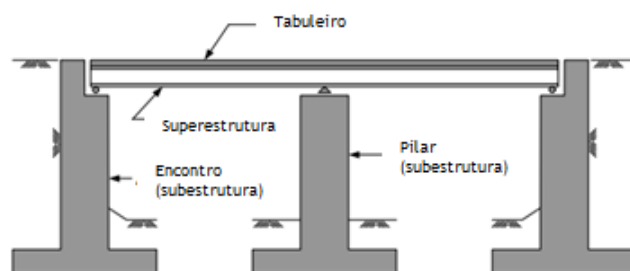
Principais componentes das pontes - tabuleiro, superestrutura e subestrutura (FHWA, 2006)
